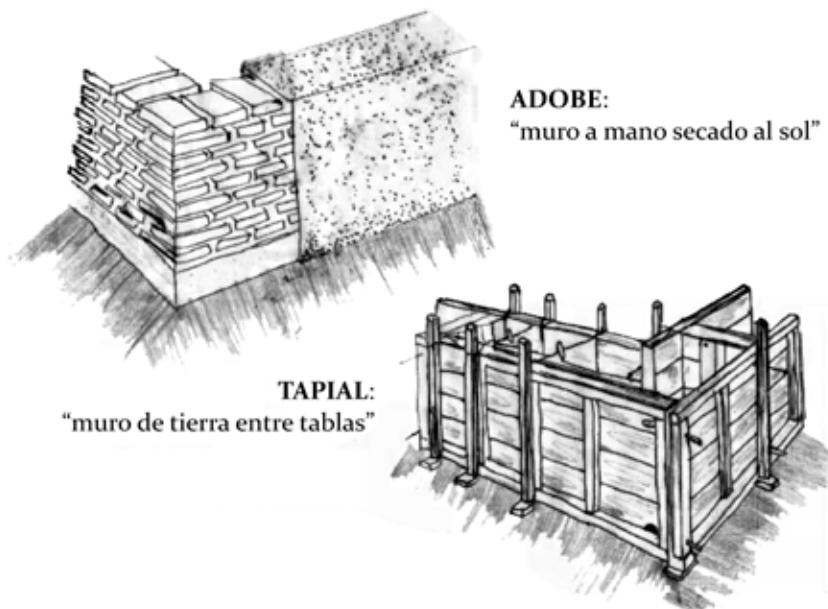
Tipos de sistemas constructivos de tierra cruda (Lara, M Lenin, 2018)
